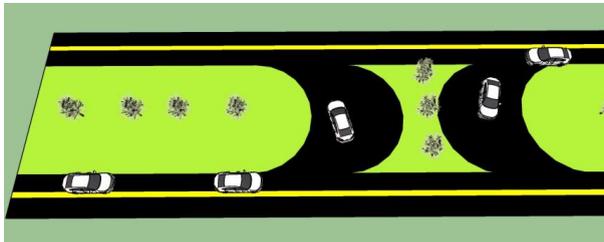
Planta baixa em 3d vista de cima, utilizando programa Sketchup, Fonte: Próprio autor.
